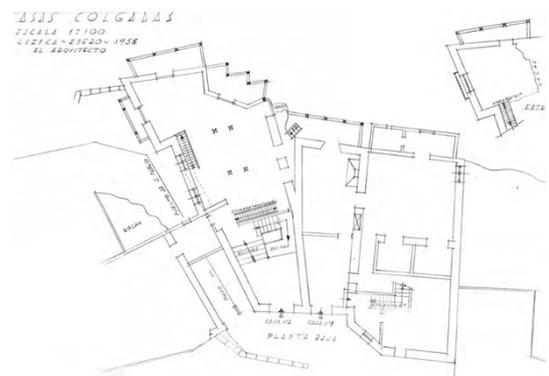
Proyecto para las fachadas de Las Casas Colgadas. Planta baja según Fernando Torrallas. IBÁÑEZ MARTÍNEZ, P.M. P. 259
